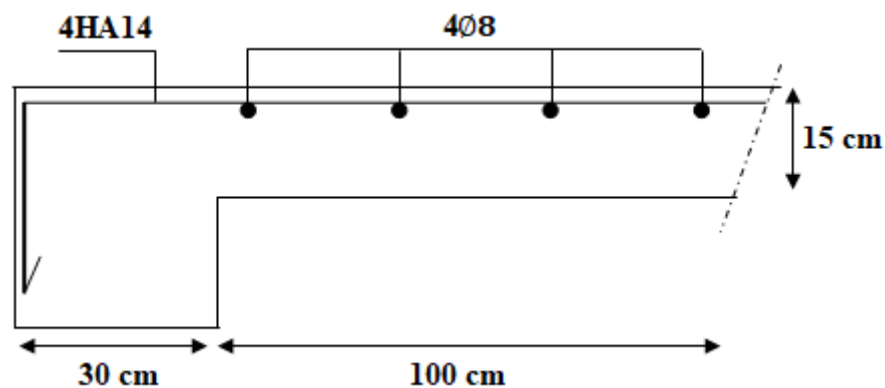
Schéma de ferrailage de balcon type 1 et 2
